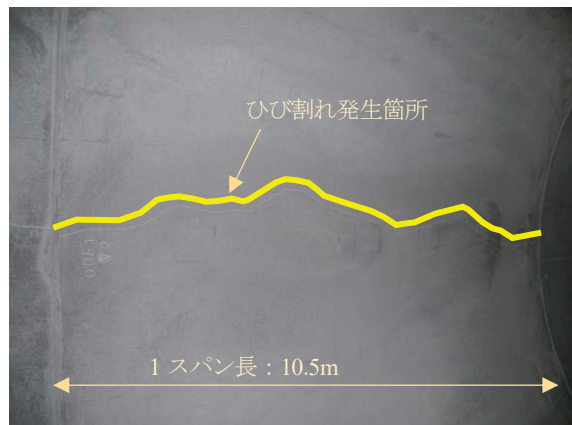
アーチ(天端)でのひび割れ発生例
